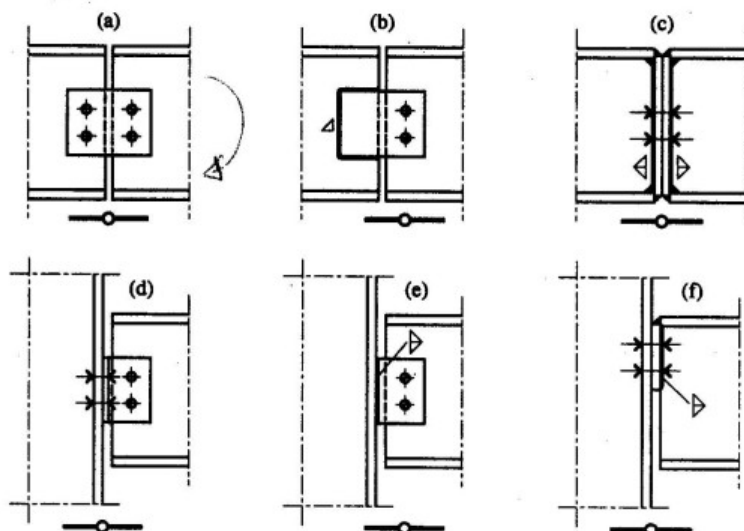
Exemples de joints de poutres et de liaisons poutre-colonne transmettant essentiellement un effort tranchant.
